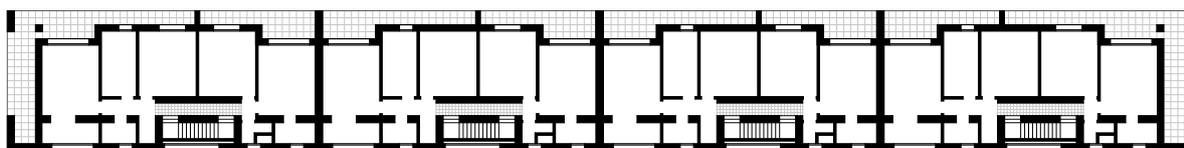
Grundriss Regelgeschoss, Sozialer Wohnbau, Figini und Pollini, 1941
